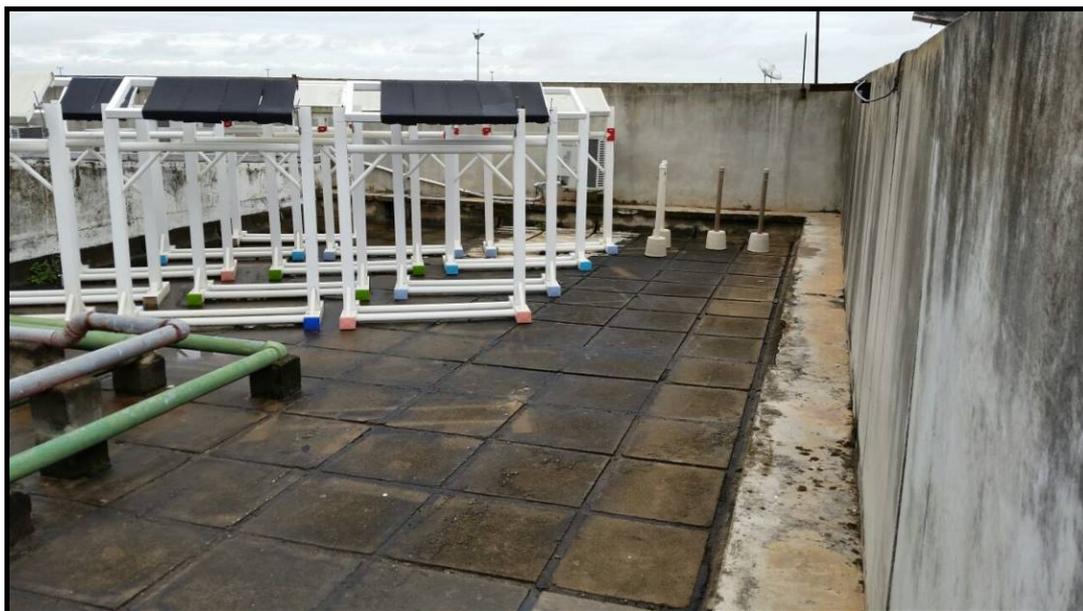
Aspecto do sistema de impermeabilização tipo A na cobertura do prédio P1 da UENF, em 2014; deterioração com perda de desempenho dos sistemas de impermeabilização originais.
